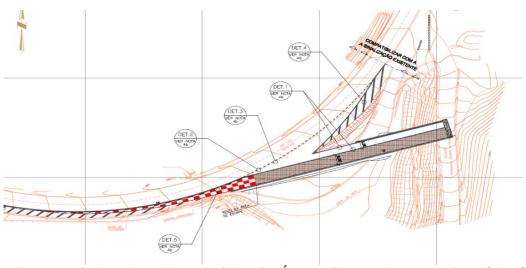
Projeto de implantação (planta) – Área de Escape Km 49+200 Pista Sul – SP-150
